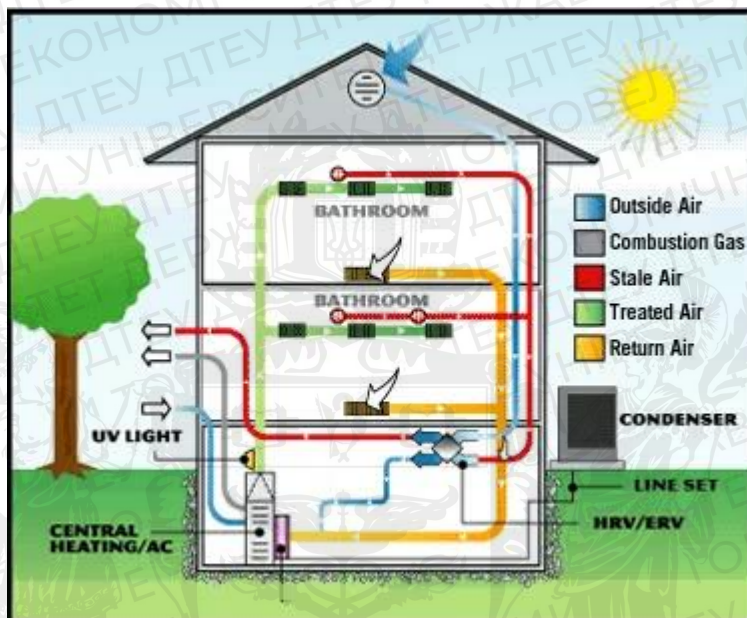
Система опалення, вентиляції та кондиціонування (Heating, Ventilation and Air Conditioning, HVAC)
